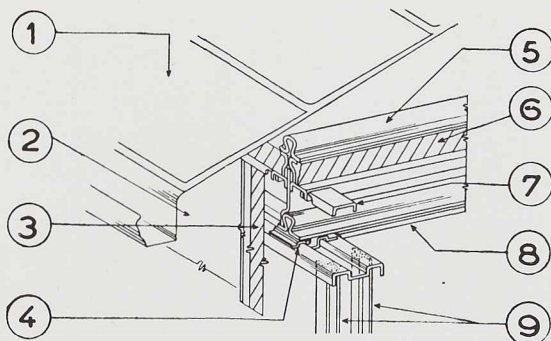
et 768. Détails de construction d'une maison préfabriquée « Lustron Home ».
